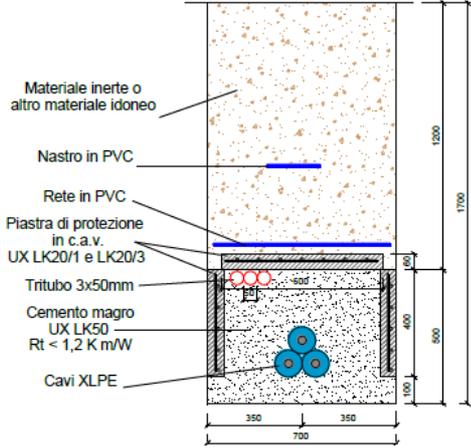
Sezione di scavo per cavidotto AT su terreno vegetale
